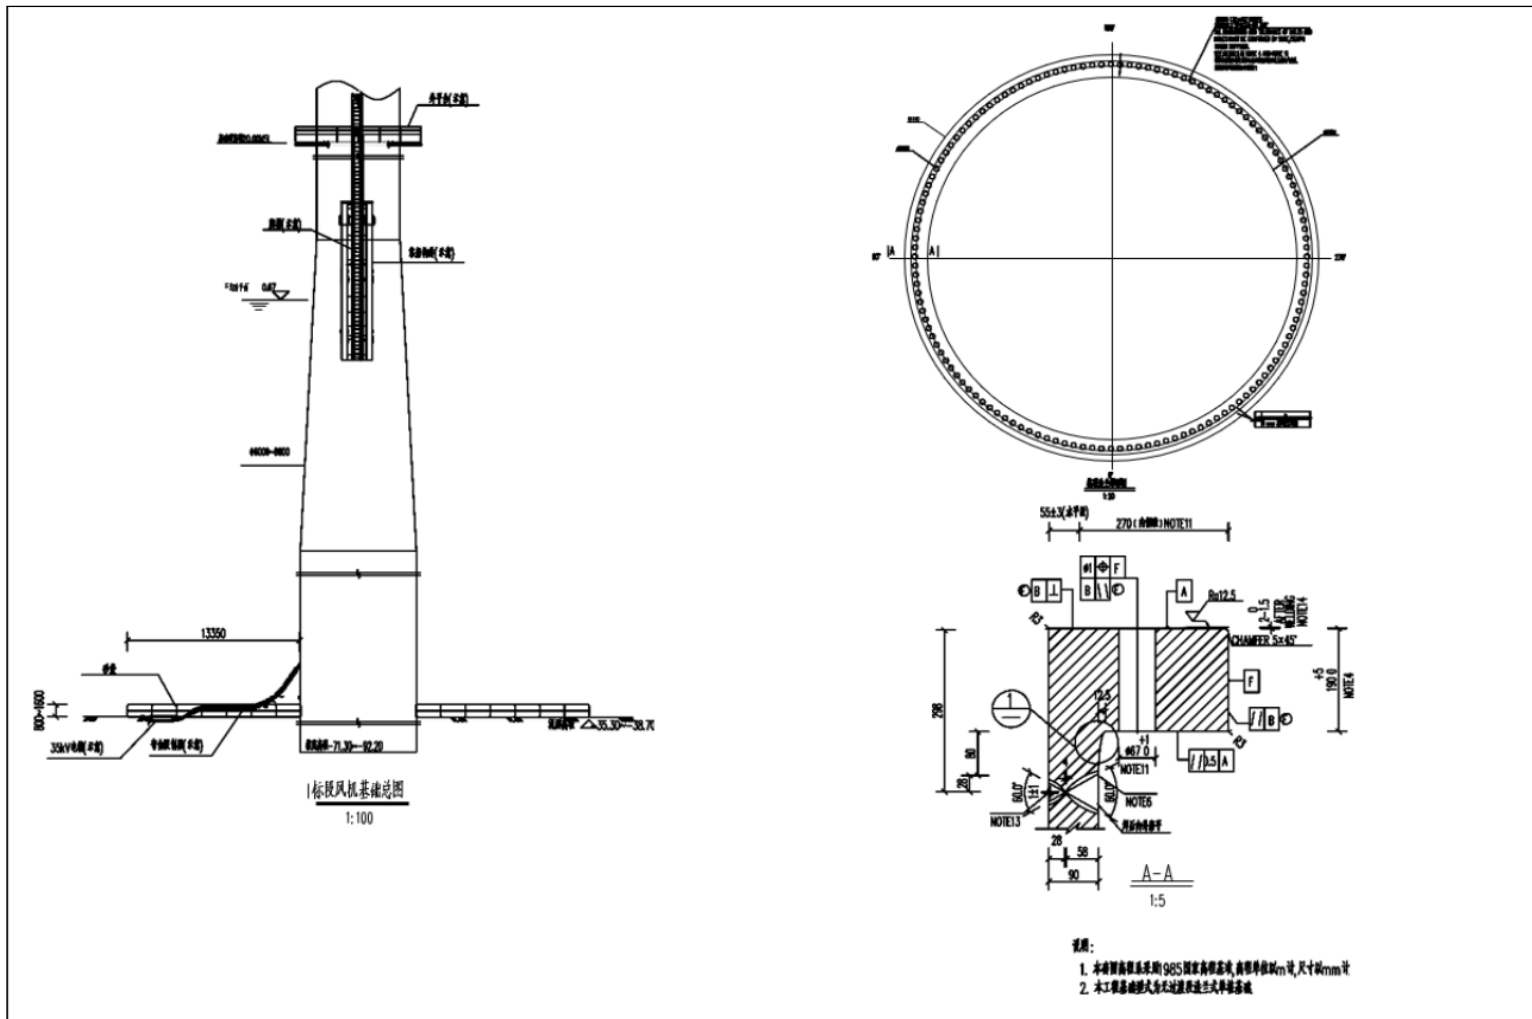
单桩风机塔基础结构剖面图 (本图由设计单位提供)
